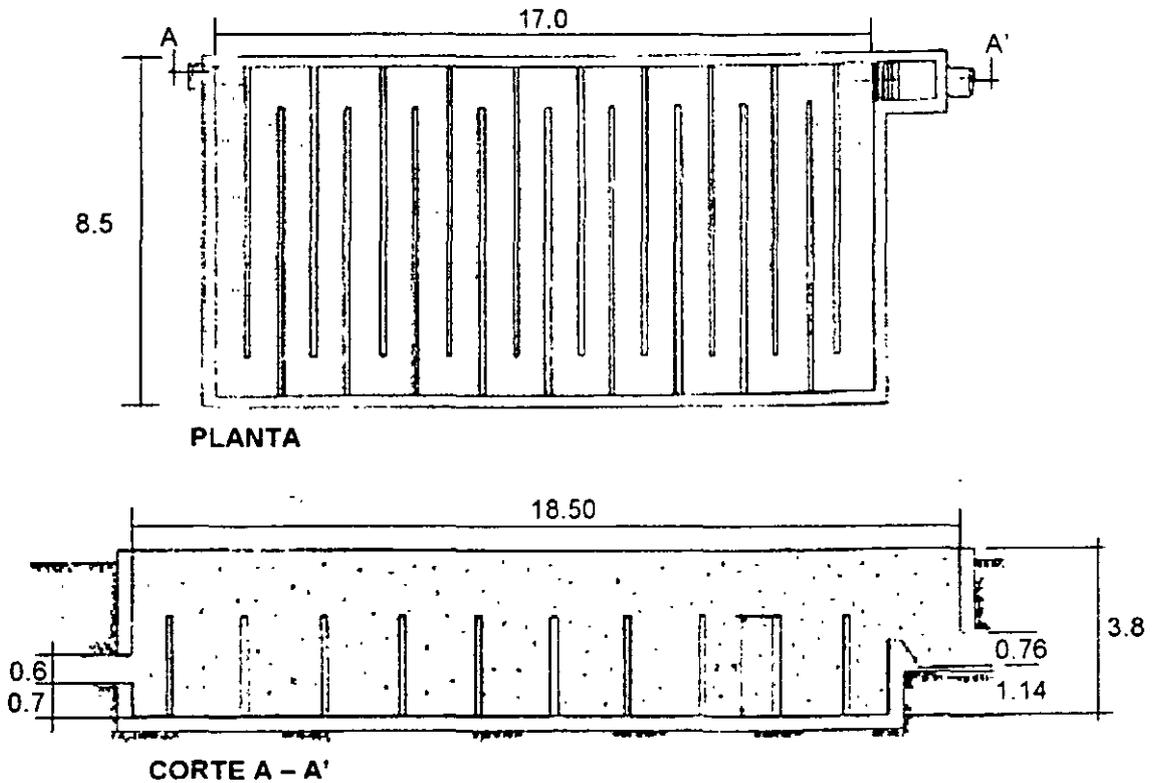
Depósito longitudinal dividido con baffles, con relación largo-ancho mayor de 40-1.
